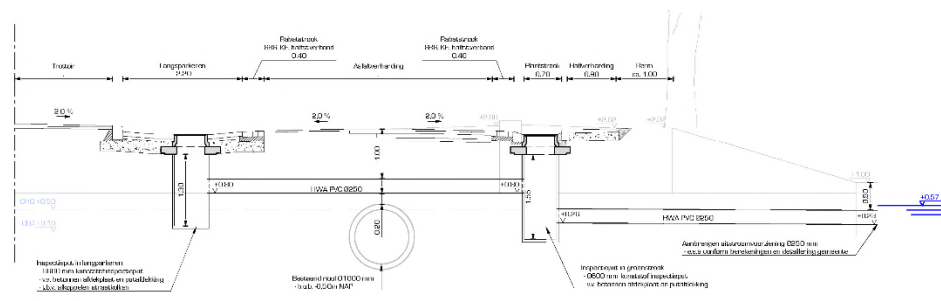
Detail HWA doorsteek Juffasehof - Ø315 mm (U1)
